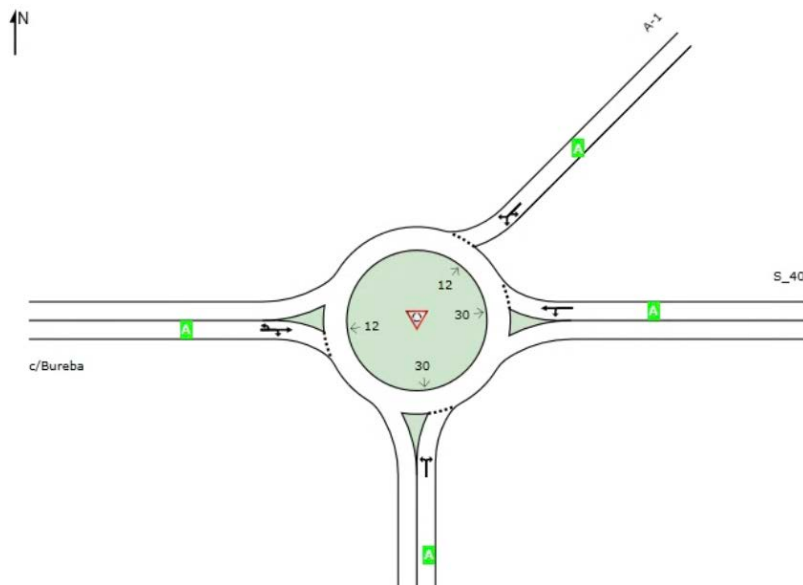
Niveles de servicio en la intersección de Campofrío para la situación prevista
